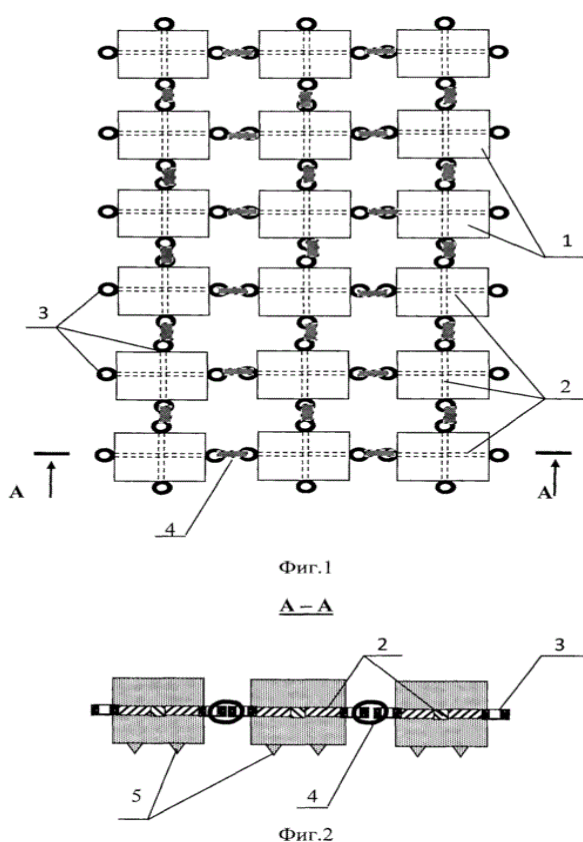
Сборно-разборное покрытие на основе полотна из бетонных блоков (патент РФ № 2740277)
